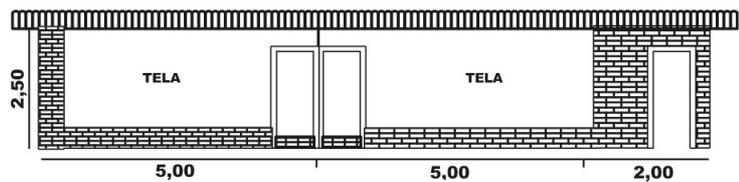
Estrutura de um módulo familiar estabilizado suficiente para a criação de 210 aves de postura.
